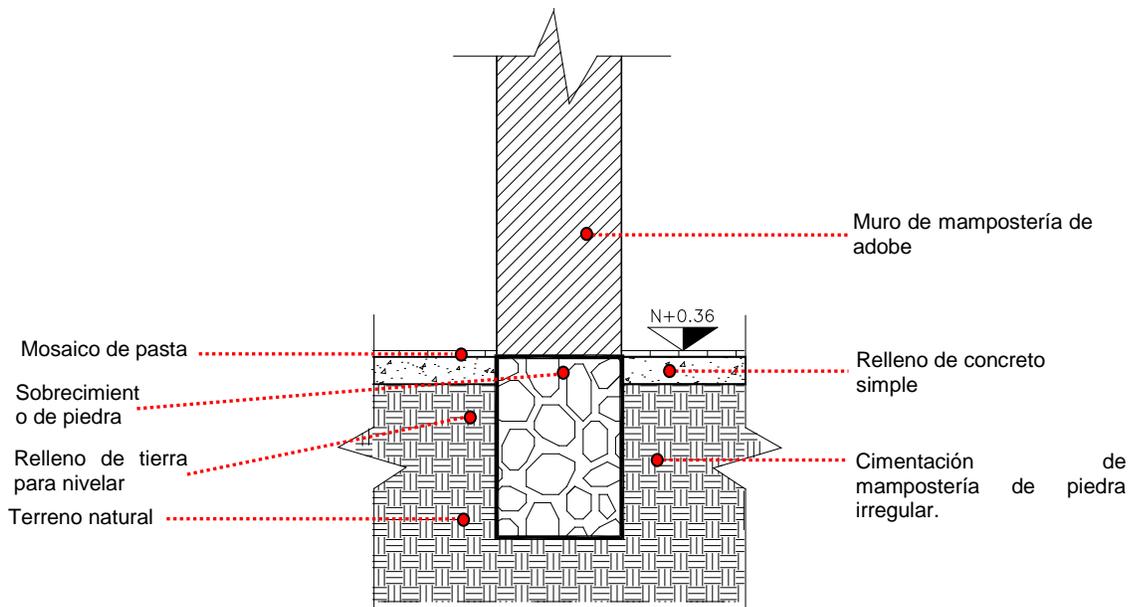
Sección de la cimentación corrida que soporta los muros de la vivienda.
